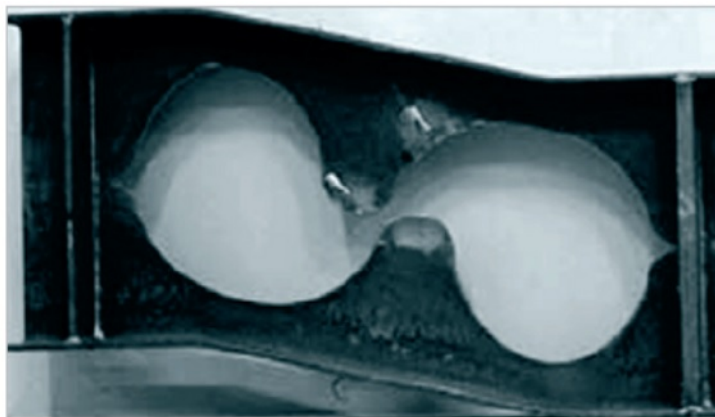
Ruptura da junta soldada, [24].
